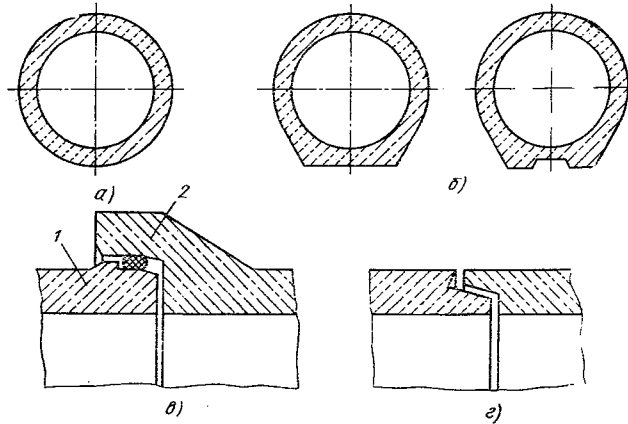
Сечения бетонных и железобетонных труб и стыков собираемых трубопроводов:
